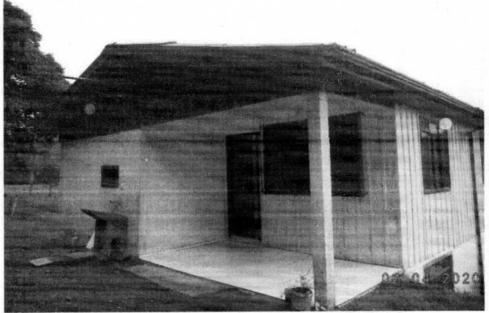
Fachada Casa Rua João Scapinello (Nelci)
